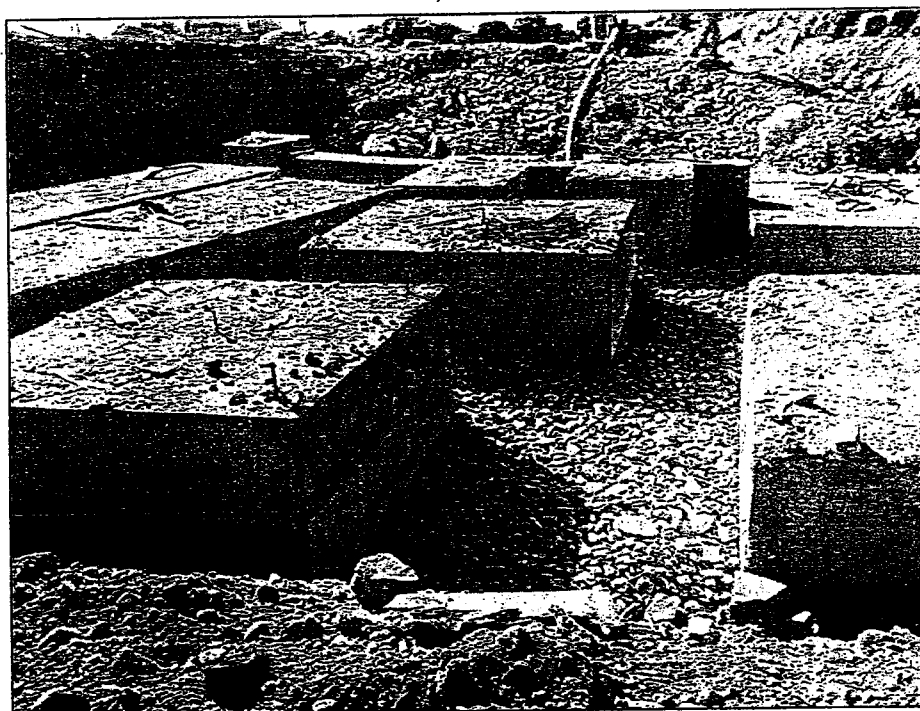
Vista del relleno entre las falsas zapatas vaciadas.
